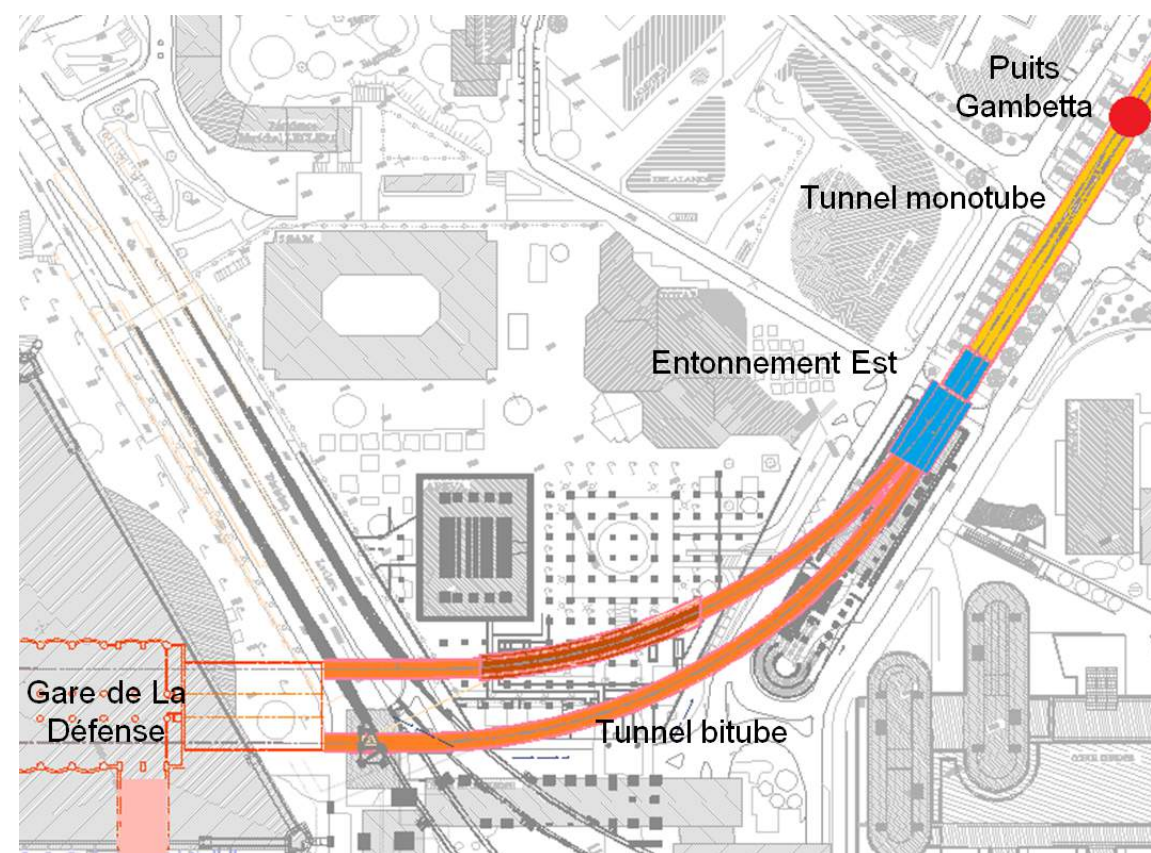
Section de tracé comprise entre le puits Gambetta et la gare de La Défense – CNIT à l'est
